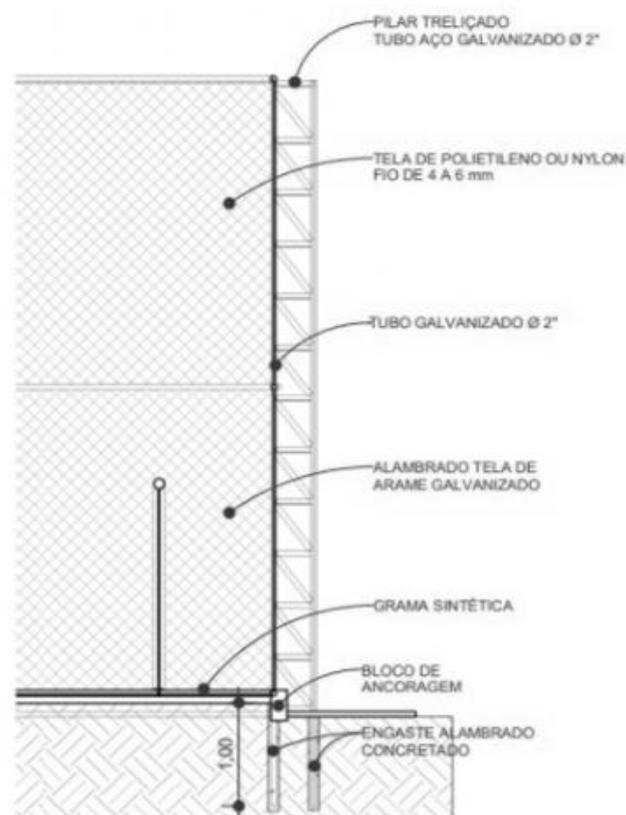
Detalhe Ilustrativo de Instalação do Alambrado e Tela (Fonte: Autoria/2021)
